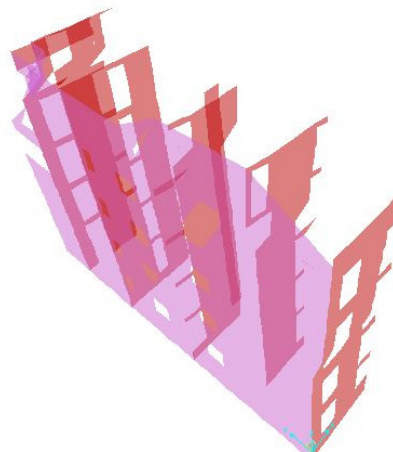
Pormenor da configuração deformada da estrutura para a acção sísmica do tipo 1
